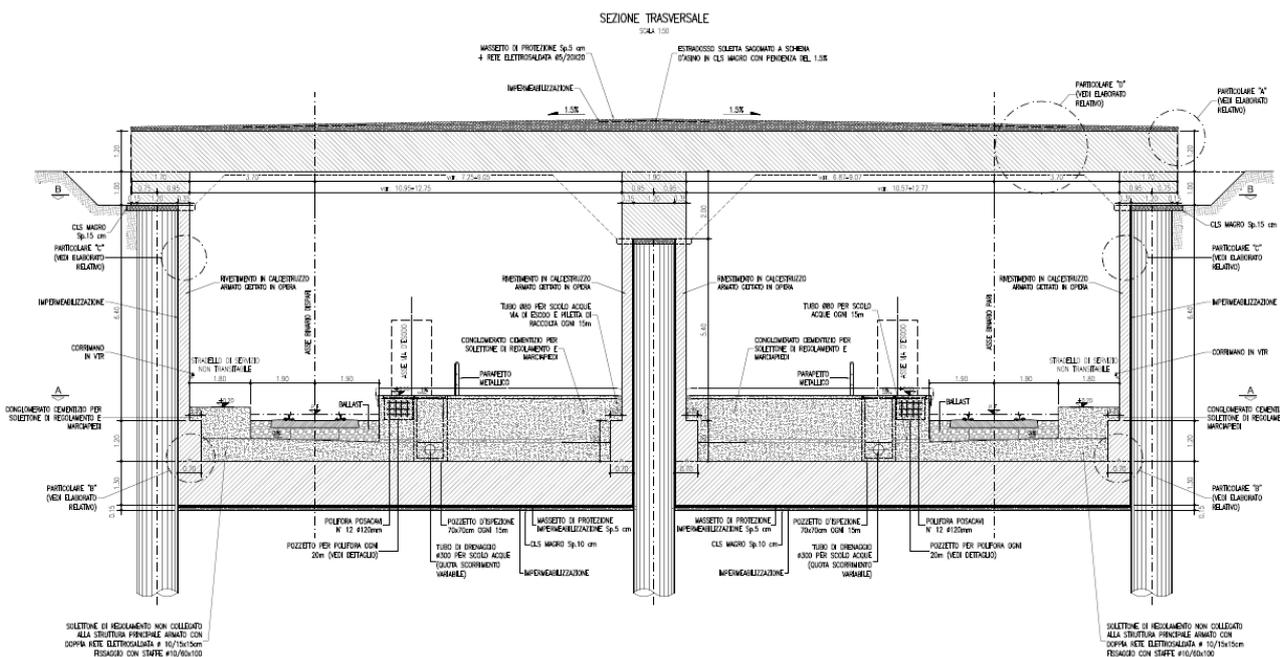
Sezione tipica M3 doppia canna con setto
